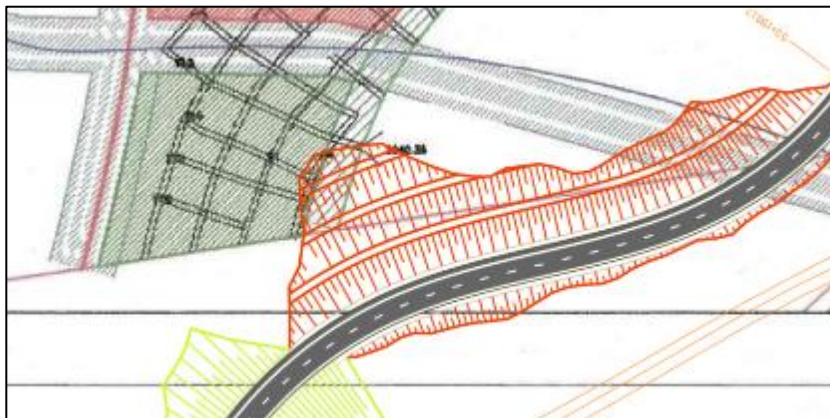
Detalle Superposición de PTO con proyecto vial UF2.
